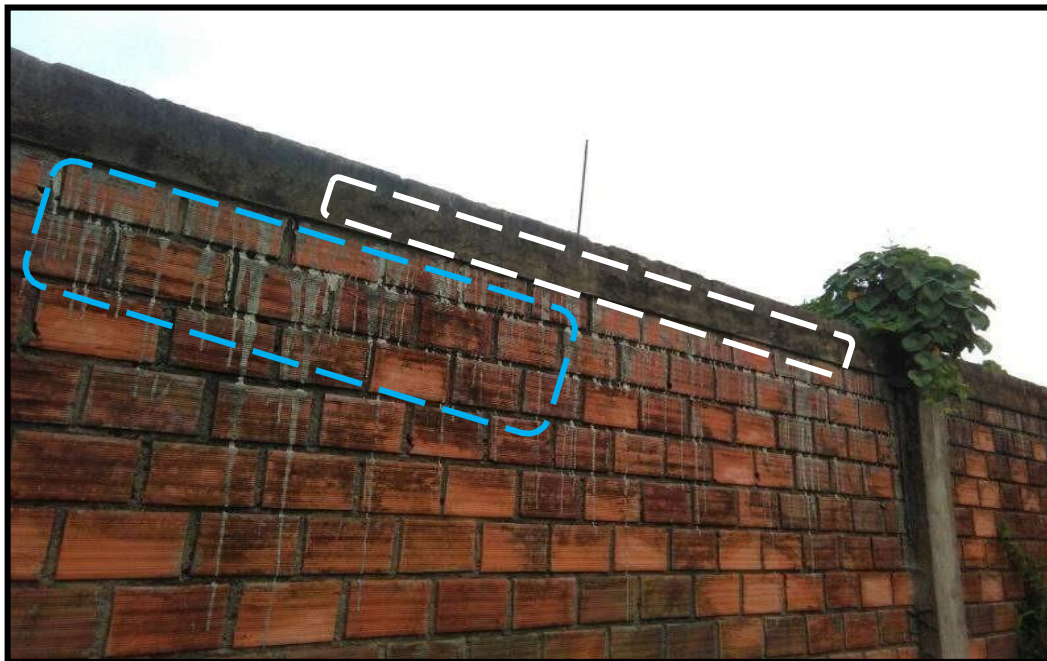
Se aprecia fisuras longitudinales en viga y popouts o cráter.
